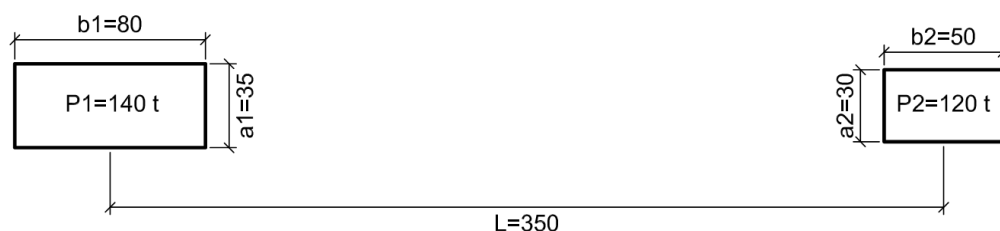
Configuração de pilares para dimensionamento de viga alavanca.
